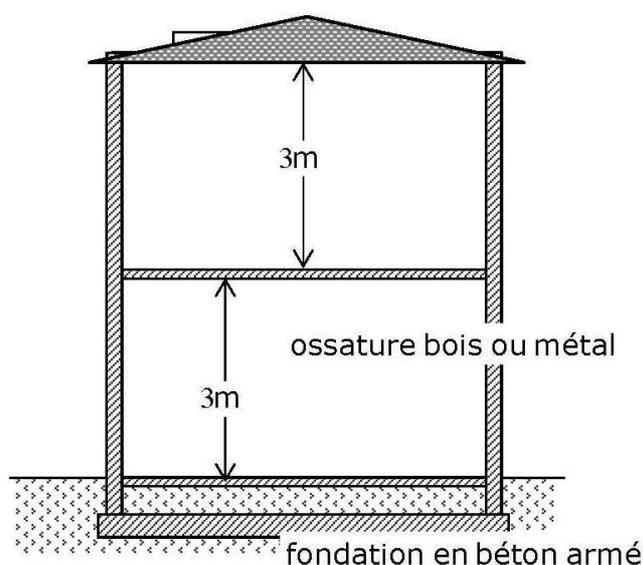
Exemple d'un bâtiment de type 5 (à ossature bois) ou de type 6 (à ossature métallique) : maison individuelle R+1
